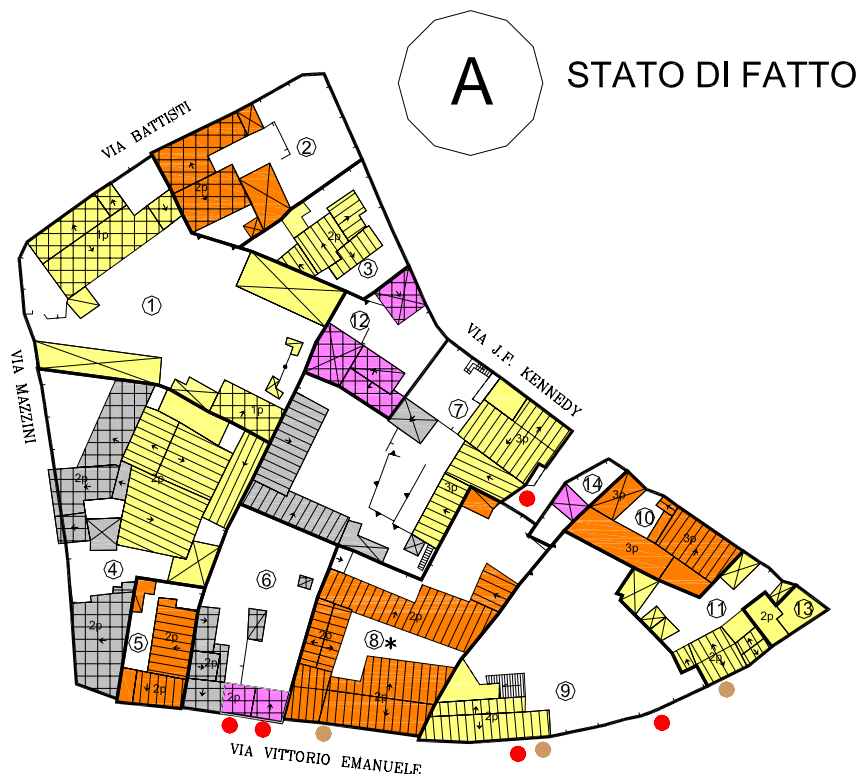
Planimetria riepilogativa dello stato di conservazione del patrimonio edilizio nell'isolato B.
